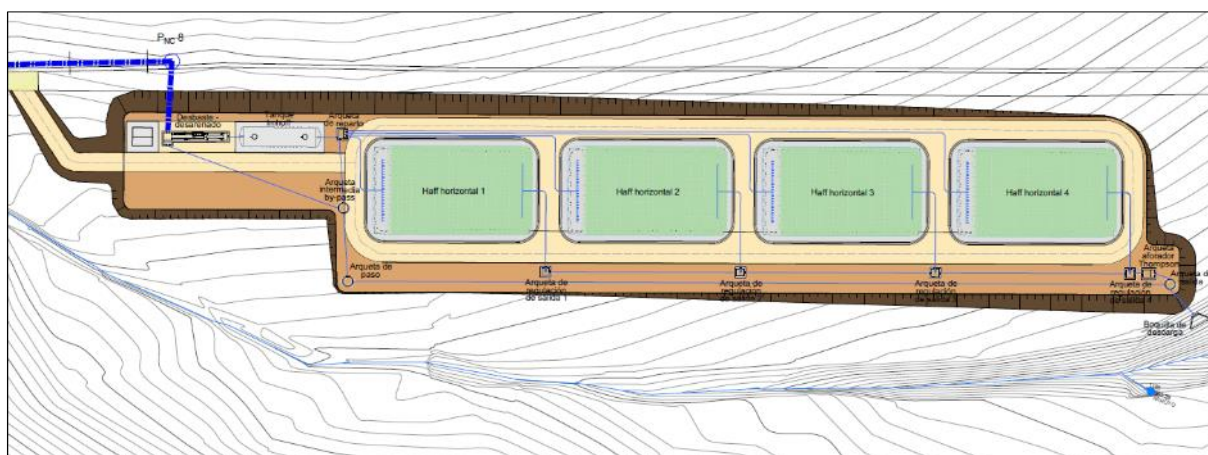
DISTRIBUCIÓN EN PLANTA
